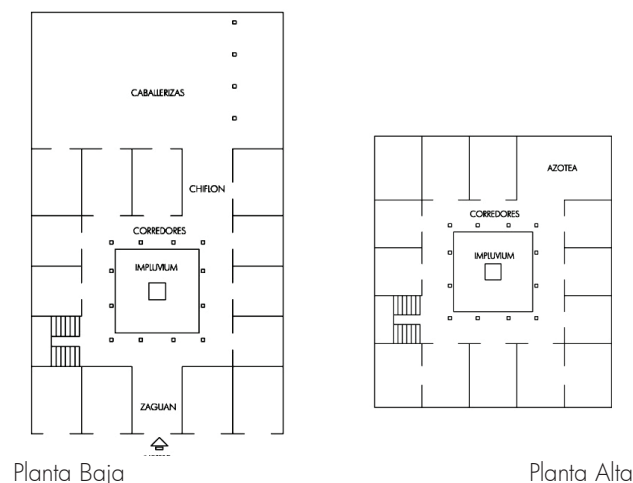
Vivienda española. Planta Baja y Planta Alta.
